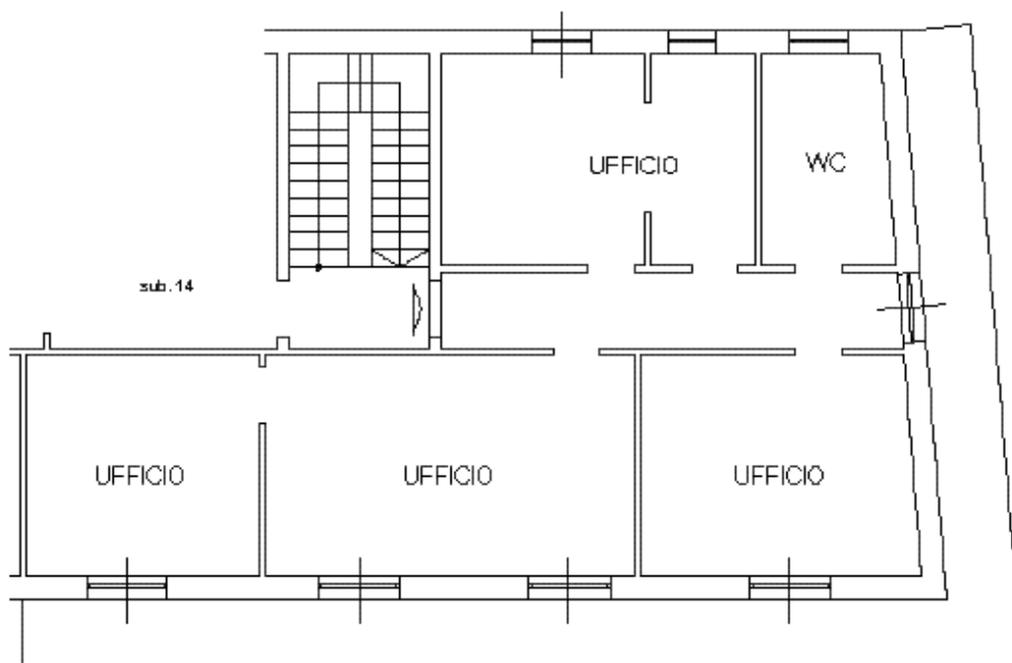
STRALCIO PLANIMETRICO DELL'U.I.U. OGGETTO DI ANALISI (FONTE: INTERNA).
